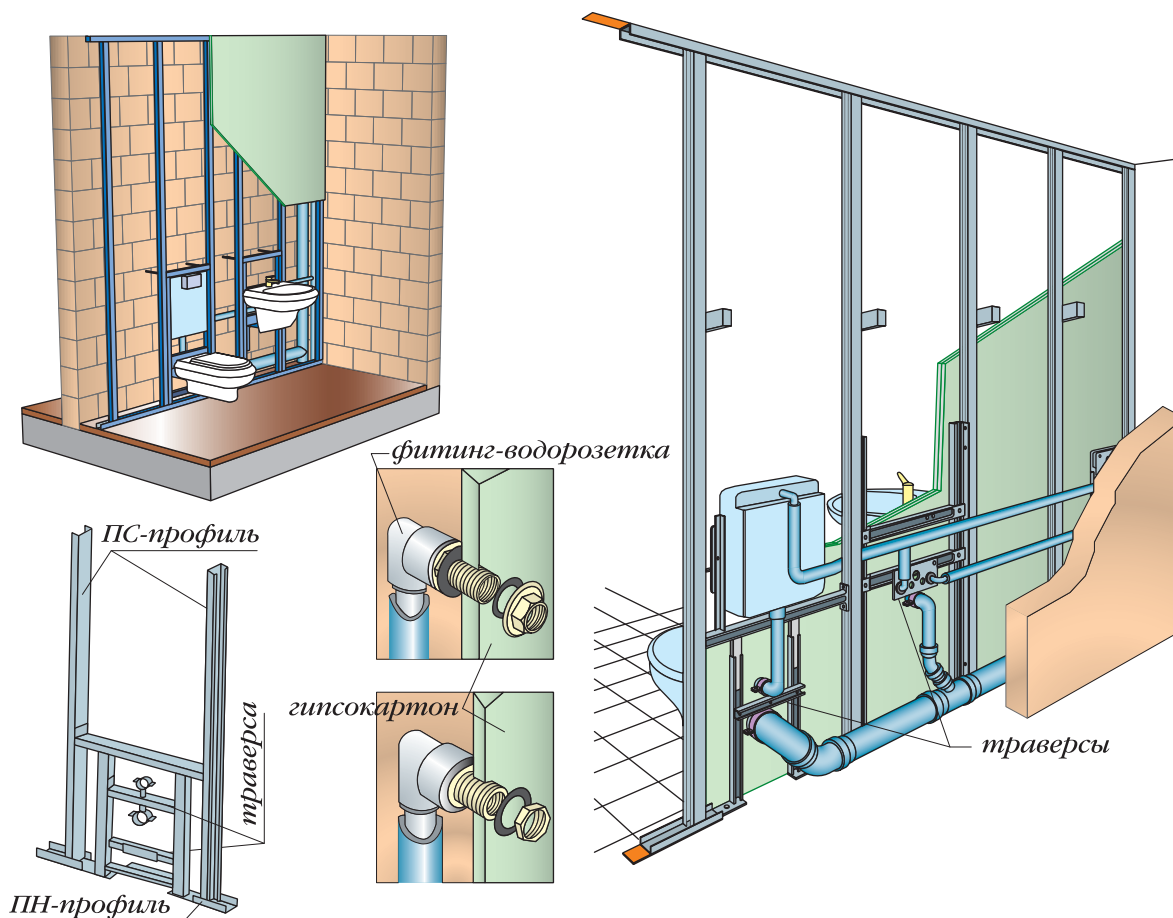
Крепление водорозеток к гипсокартонным перегородкам
